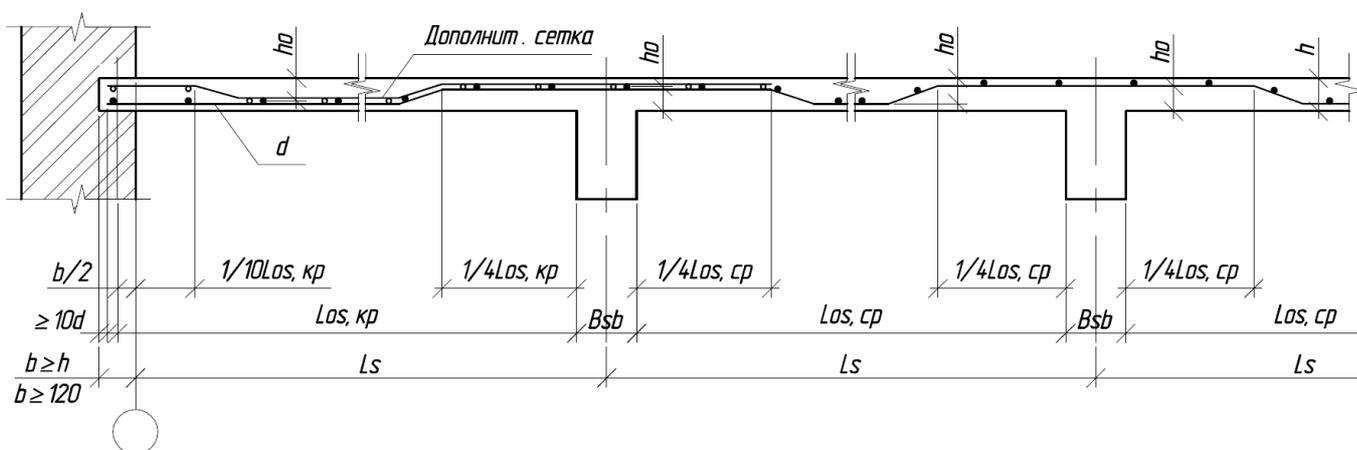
Непрерывное армирование сварными рулонными сетками
